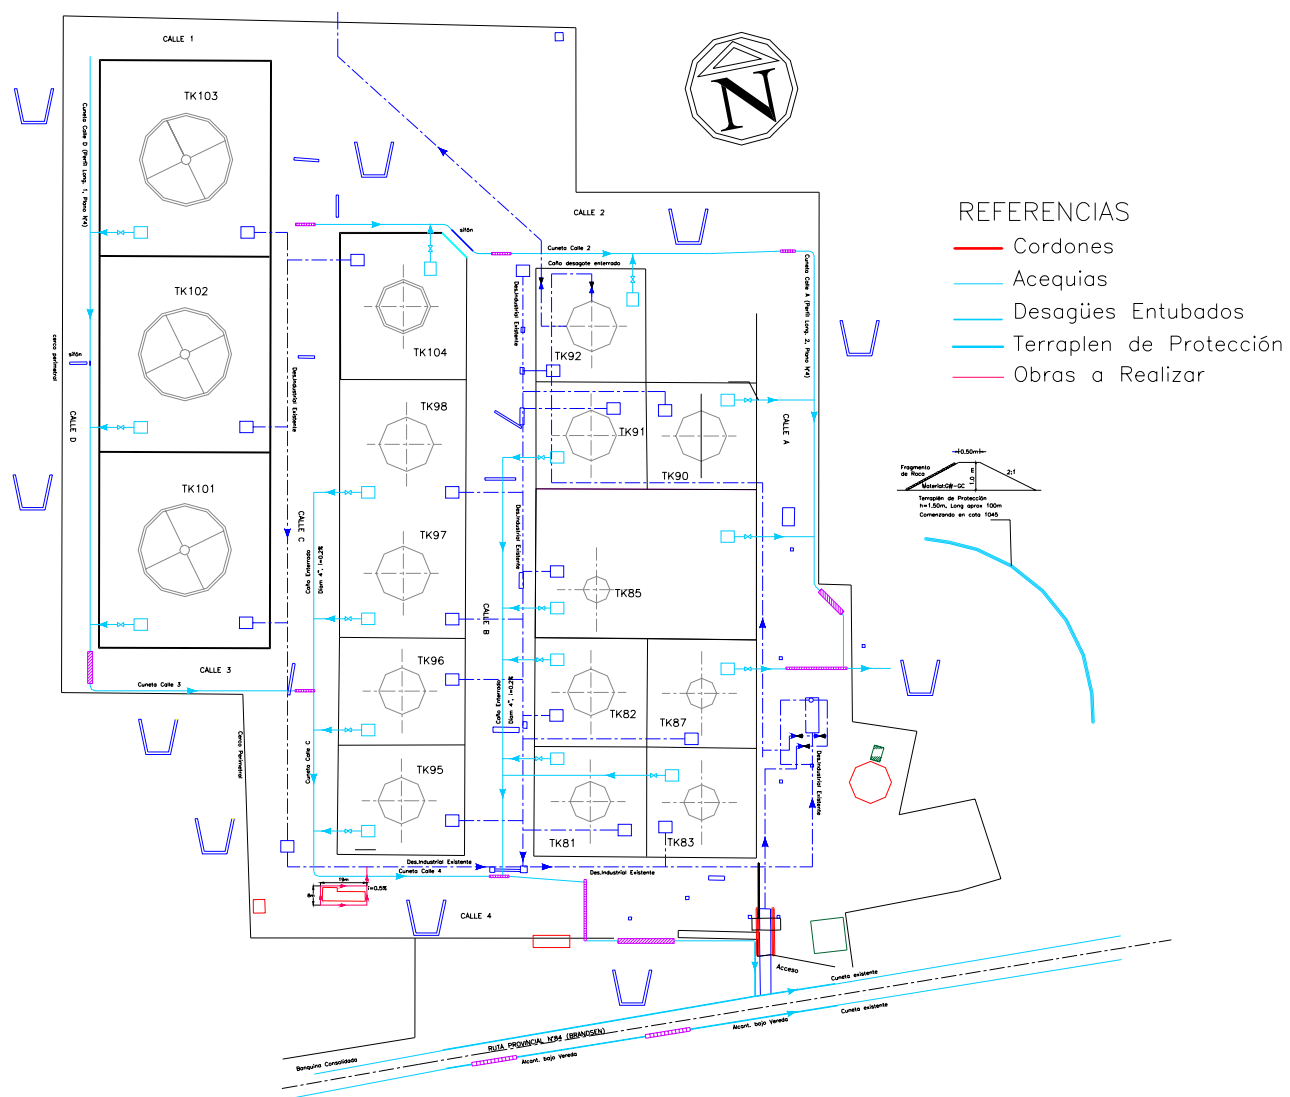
OBRAS A REALIZAR EN ZONA NORTE
